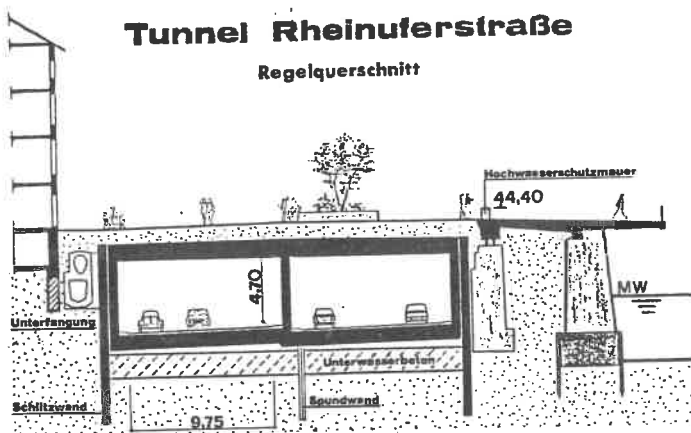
Querschnitt des im Bau befindlichen Umwelttunnels in Köln
